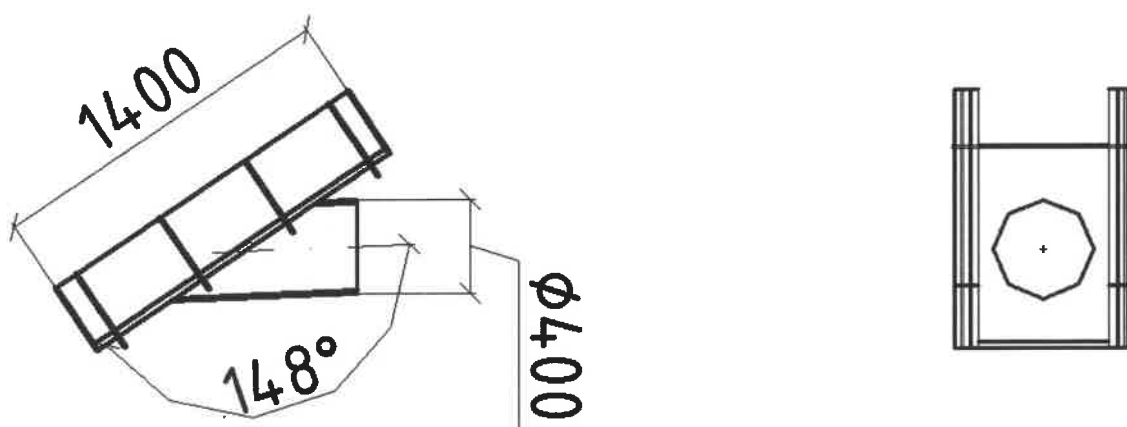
ВД-003.1-1 Быстроток соединительный 400х600 с патрубком.
